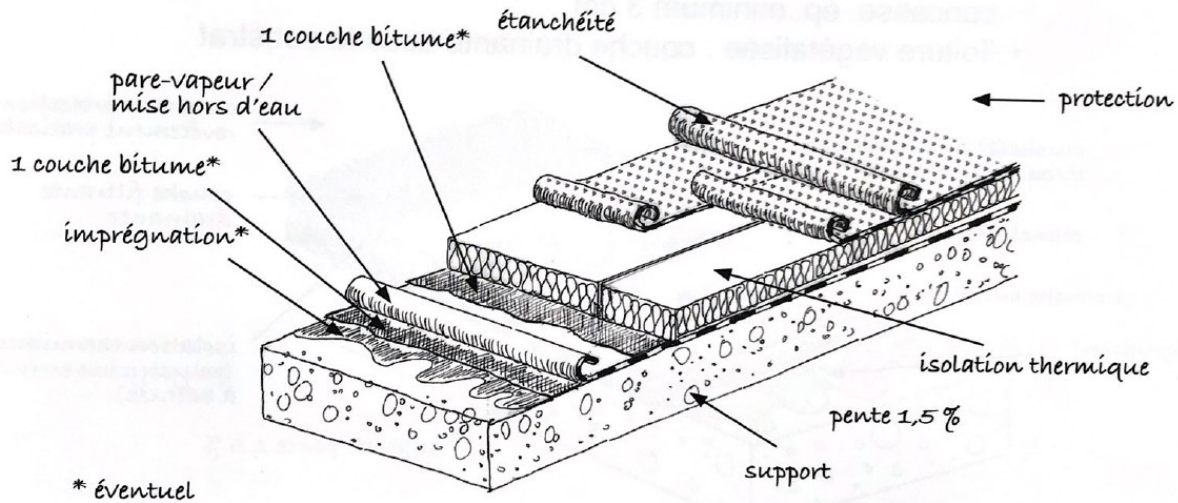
Détails des couches d’une toiture chaude traditionnelle (DOURNOW, 2014)
